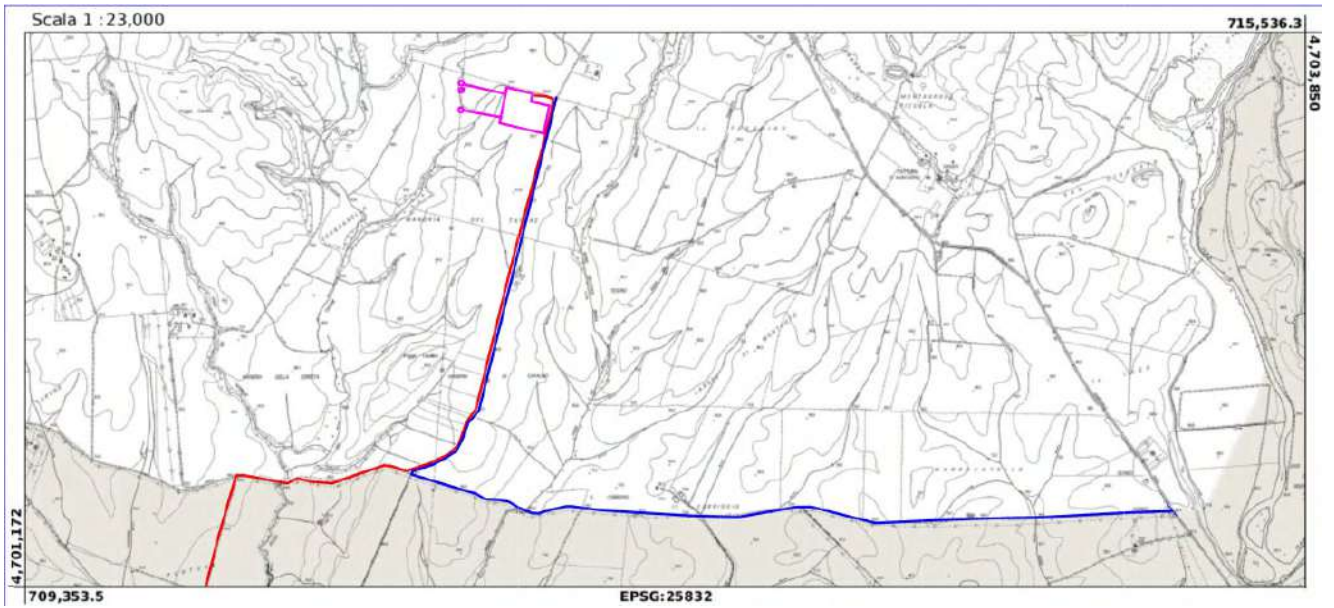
progetto su CTR Toscana: in magenta: Stazione Elettrica e trallicci; in rosso: cavidotto interrato; in blu: viabilità oggetto di sistemazione
